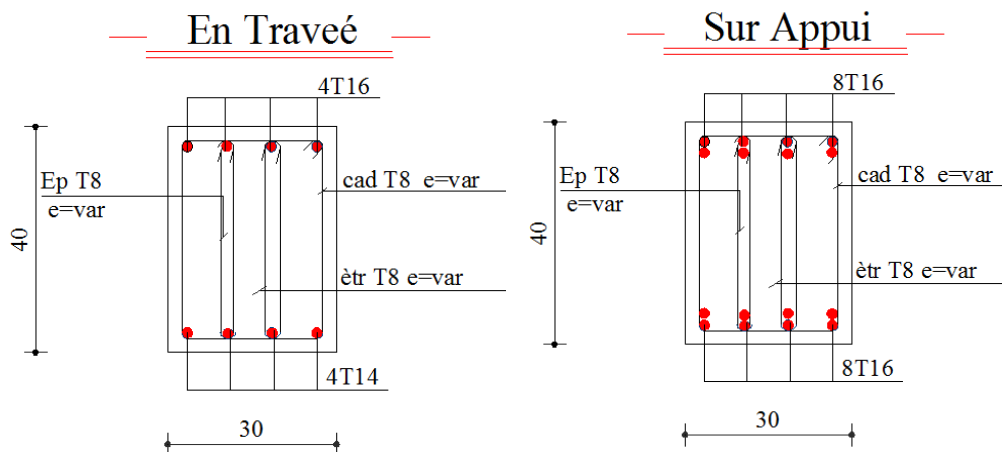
Ferrailage des poutres secondaires (30*40).
